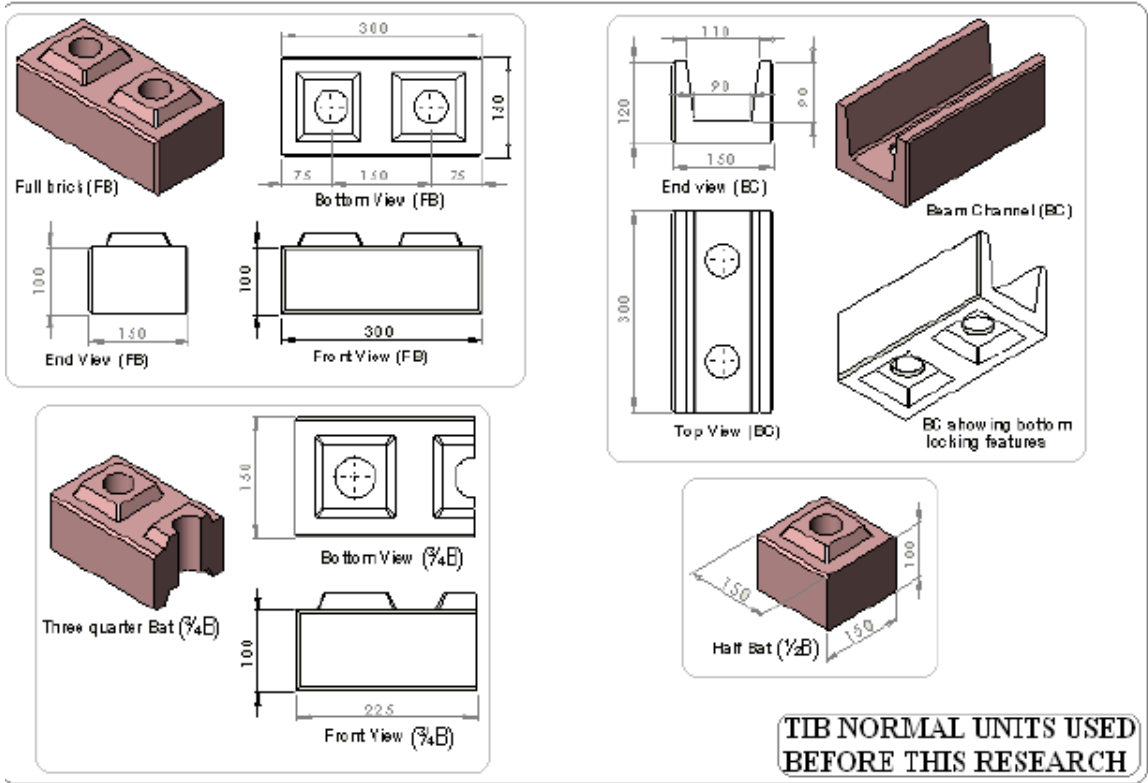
Sistema tailandés para muros sin juntas de mortero (Simion, 2009)
